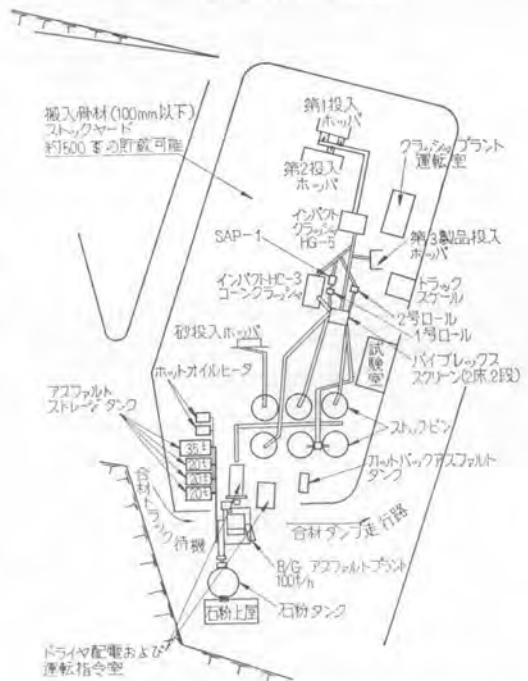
アスファルトプラントおよびクラッシングプラント基地機械配置図
